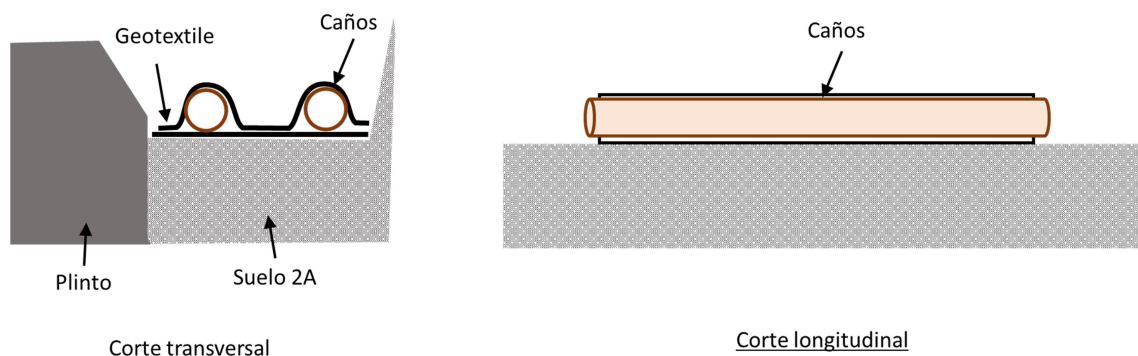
Tuberías y geotextil en el fondo de la zanja
